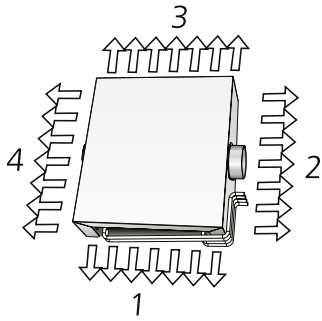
Draufsicht PARASOL EX 690, Seite 1-4
